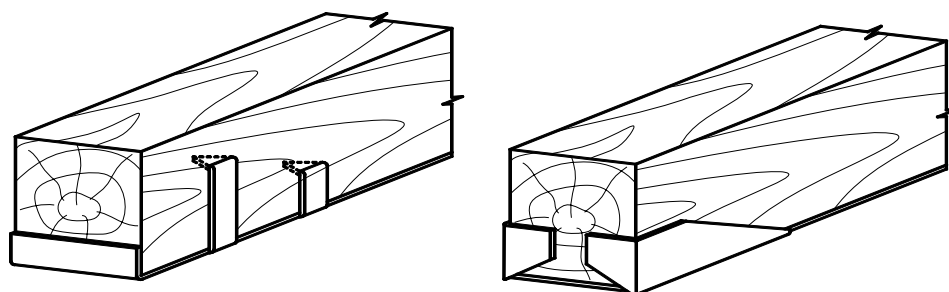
Брусчатые балки с усиленной растянутой зоной
